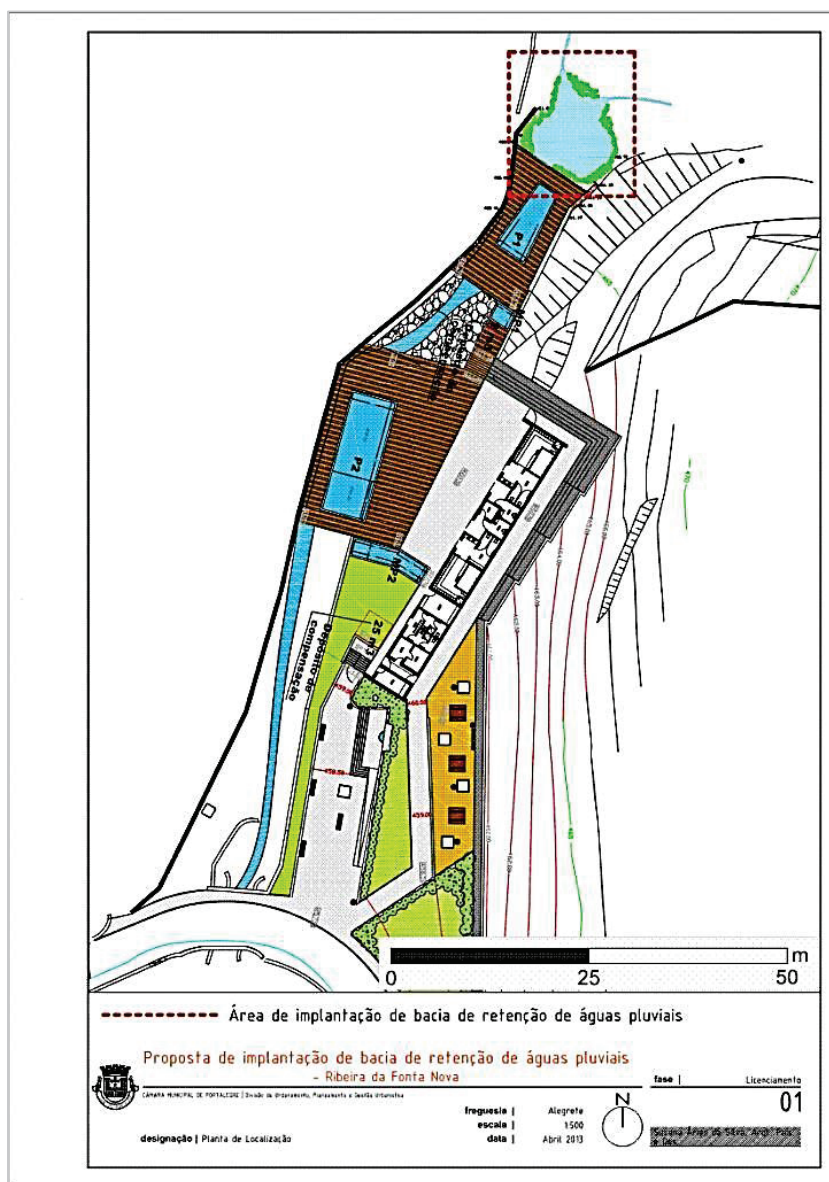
Planta de localização - 01 - Proposta de implantação de Bacia de Retenção de águas pluviais - Ribeira da Fonte Nova em Alegrete
